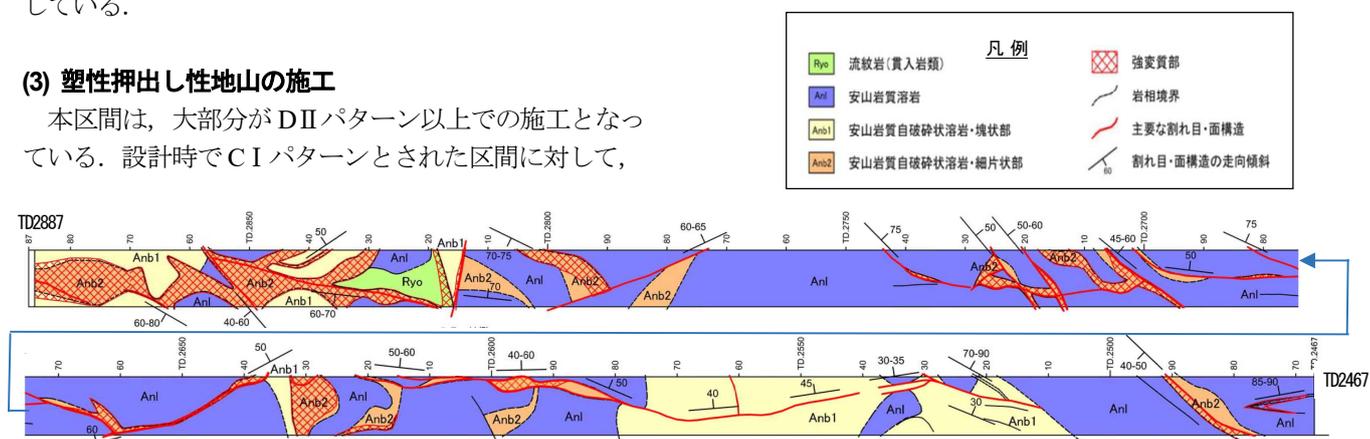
地質水平断面図 (SL) (TD2,467～2,887 m)
